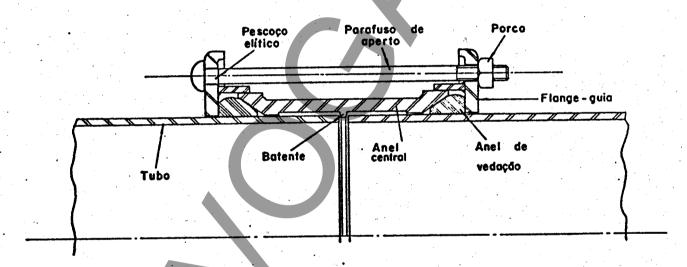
Exemplo de junto tipo Dresser de montagem
